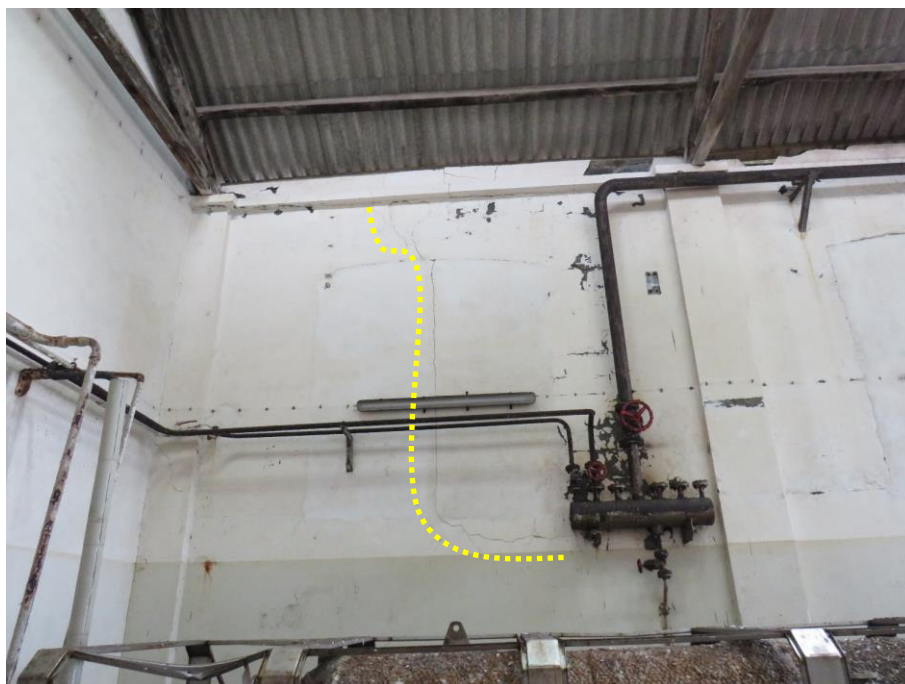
Fissuração em parede Nascente do Compartimento 11.6.
